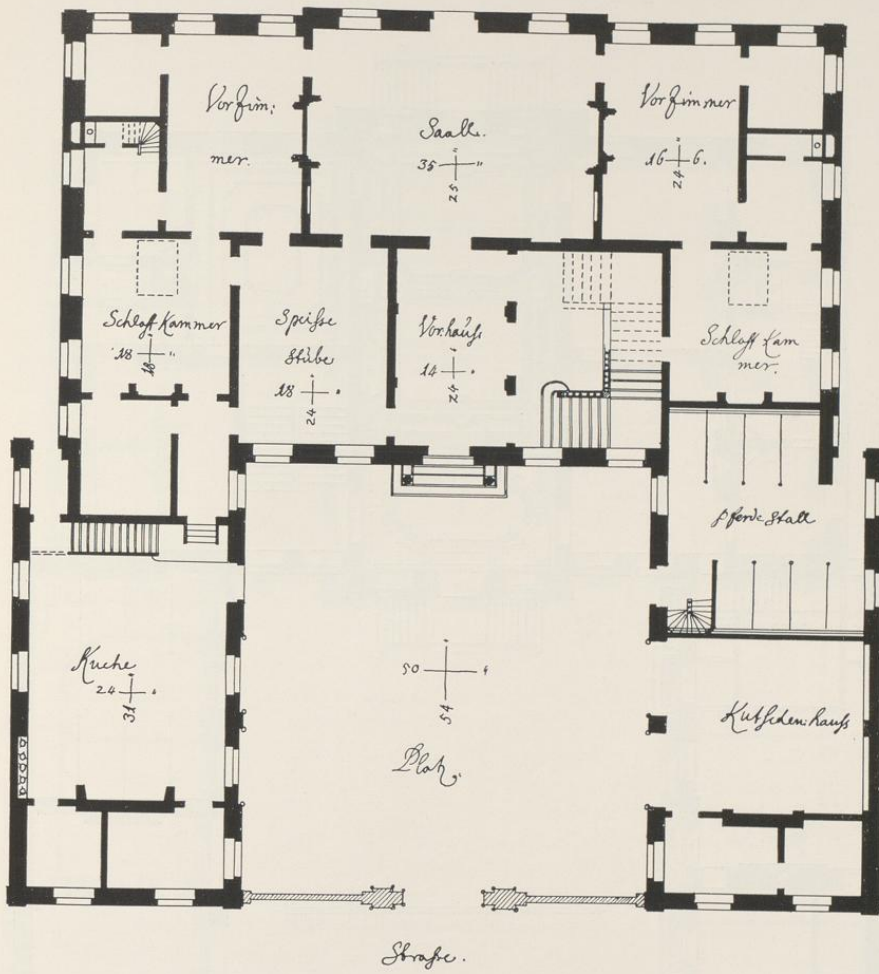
Grundriß des Erdgeschosses eines vierten Entwurfes. Pause der Bauzeichnung Nr. 677
